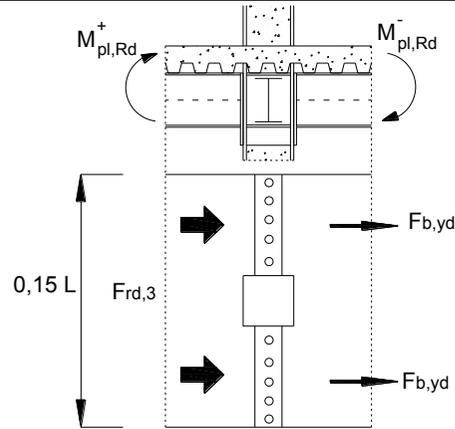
Meccanismo 3 – Connettori a taglio sulle travi secondarie
